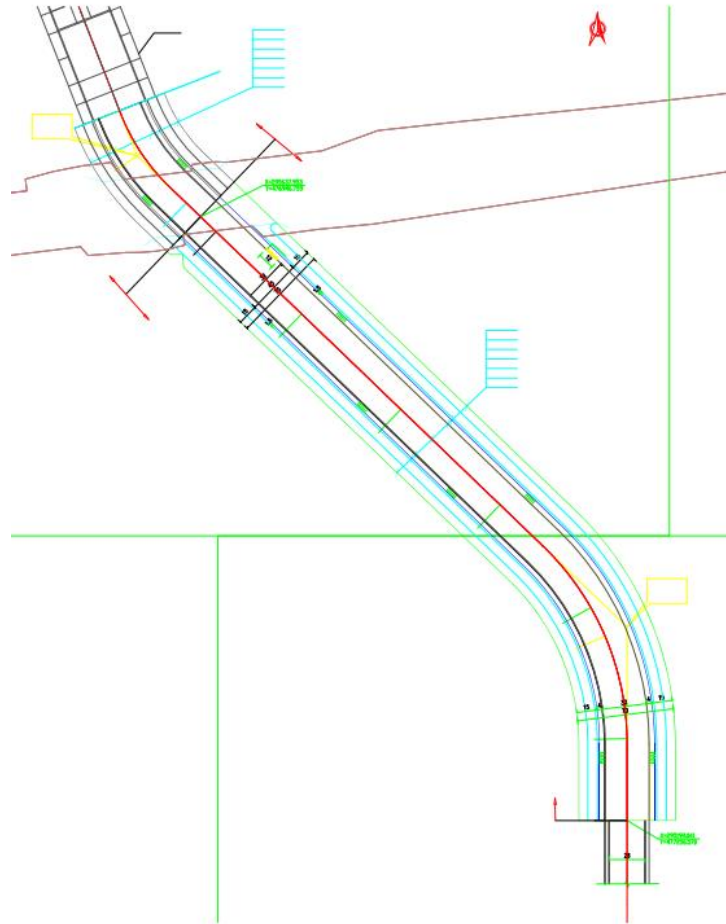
工程平面布置图 (0+098.094~0+659.534 段)
